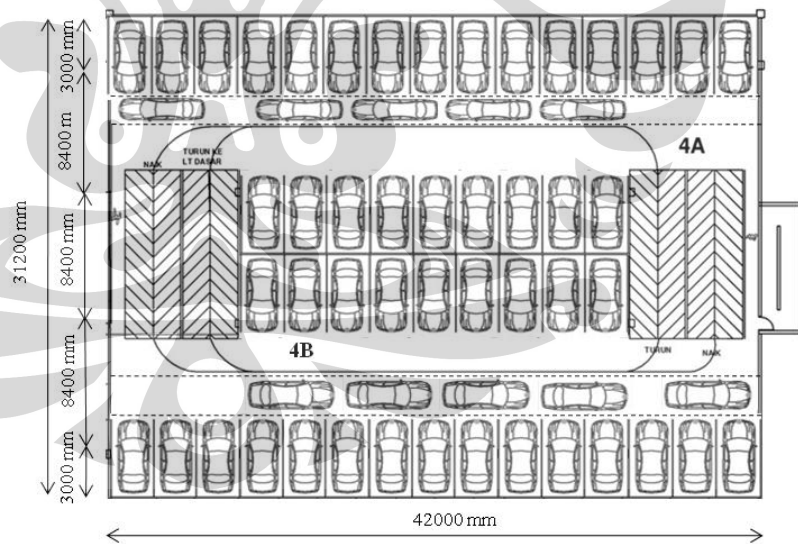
Layout* gedung parkir eksisting lantai 4 – 12
